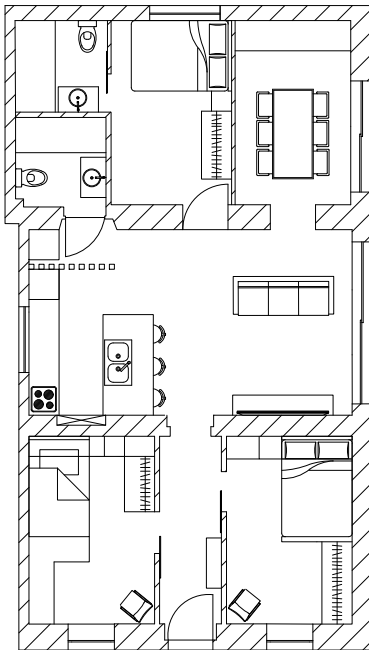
Planta de estudo 1 em 2D (Fonte: Rita Giro, 2025)
